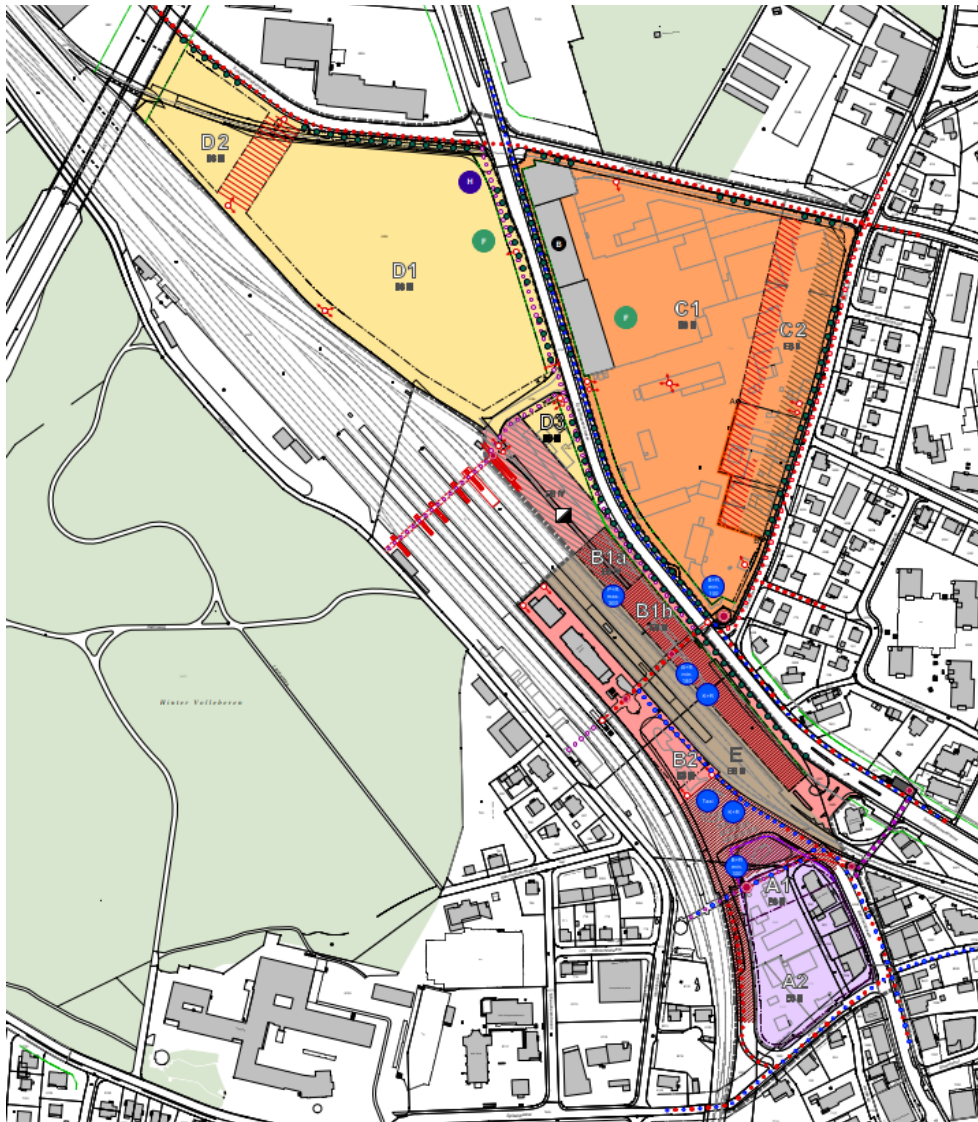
Situationsplan öffentlicher Gestaltungsplan Bülach Nord.
